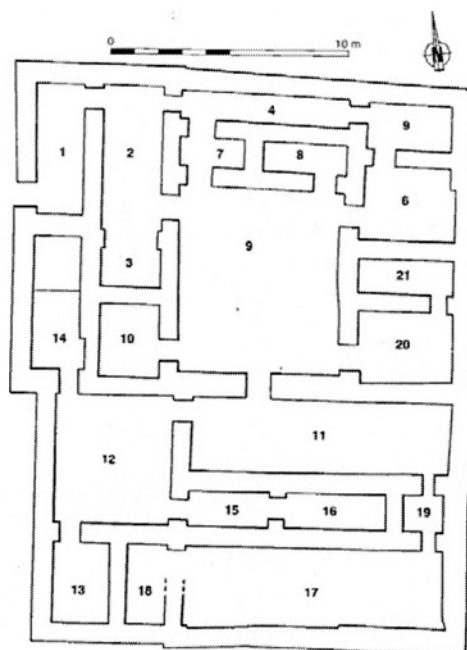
Plan de la maison B 59 de Larsa (dessin J. Suire)
